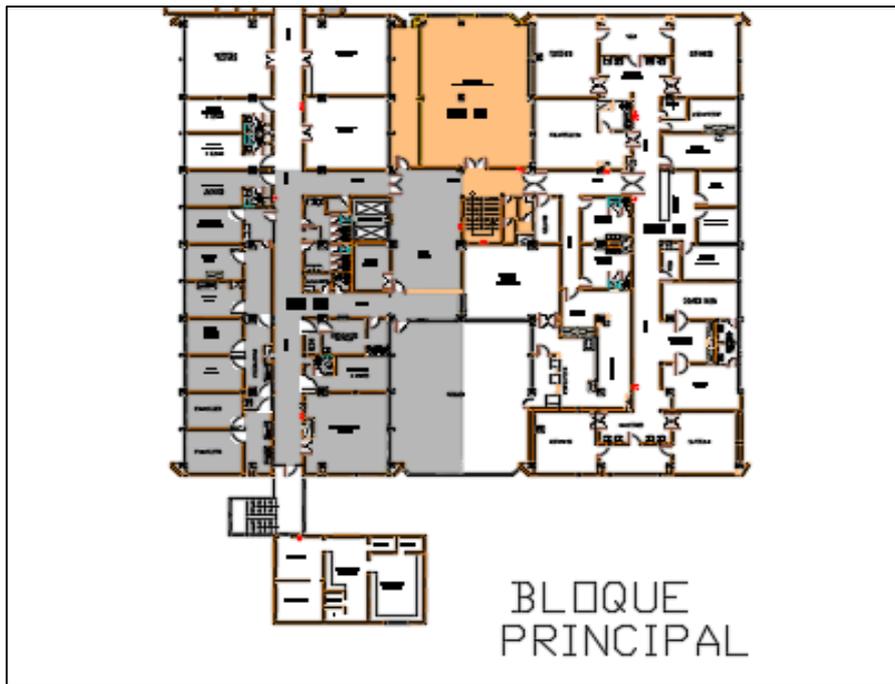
Primera planta del bloque principal del Hospital Homero Castanier Crespo
